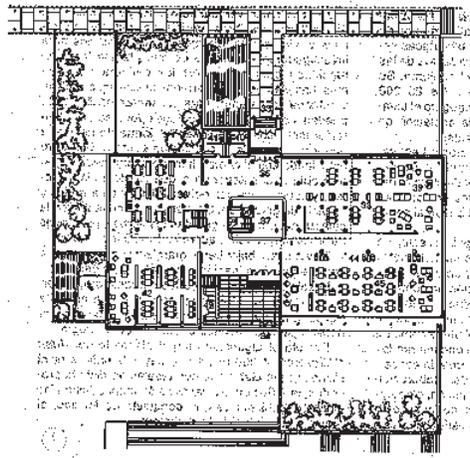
Planta de la Biblioteca Central. Juan O' Gorman.
